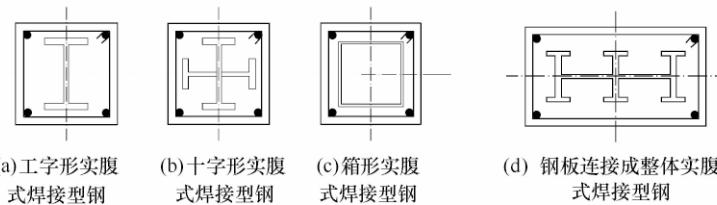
型钢混凝土柱的型钢截面配筋形式
